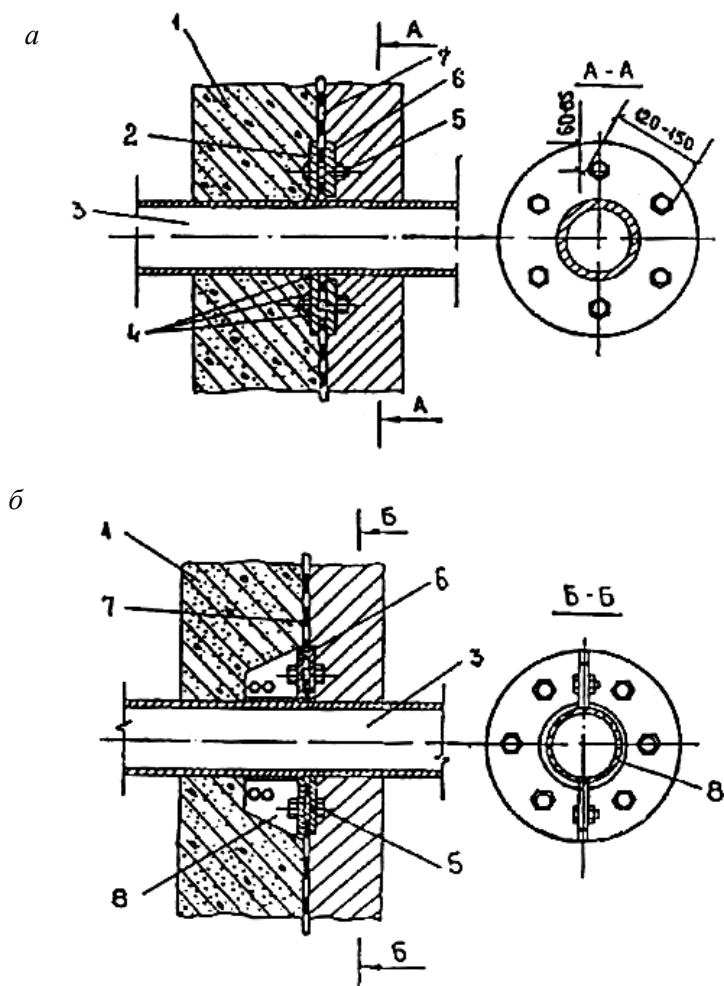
Сопряжение гидроизоляции с трубопроводом:
